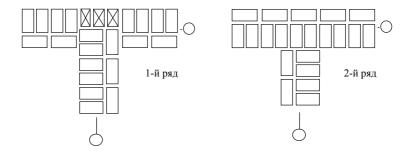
Кладка примыканий стен толщиной в 1,5 кирпича
